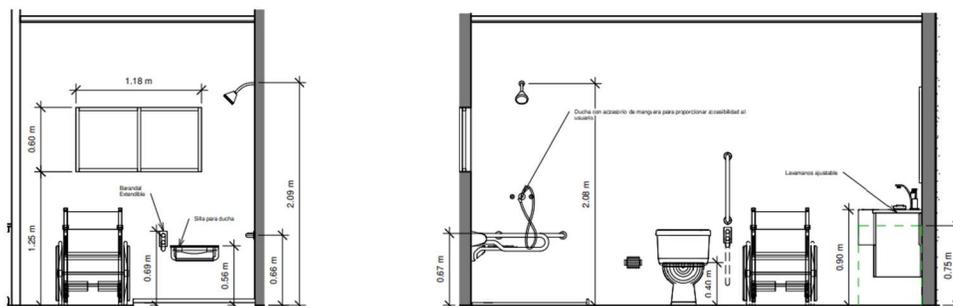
Detalles de baños para villas de adultos mayores. Fuente: Elaboración propia.
